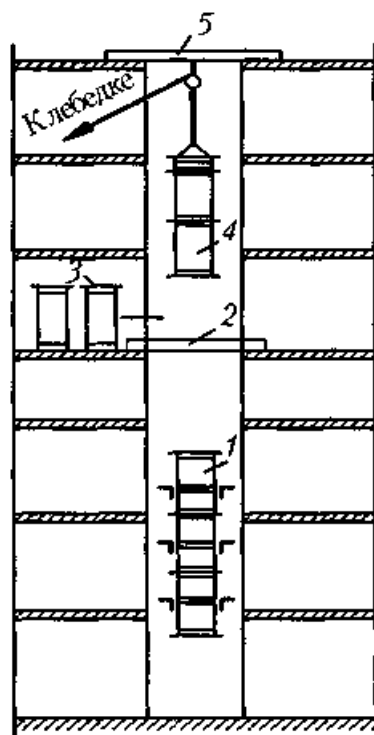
Монтаж вертикальных воздуховодов методом наращивания сверху:
